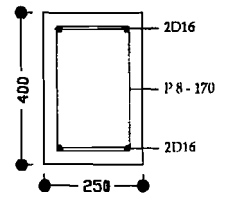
Denah Rencana Balok Anak Lt 2 s/d Lt 4
